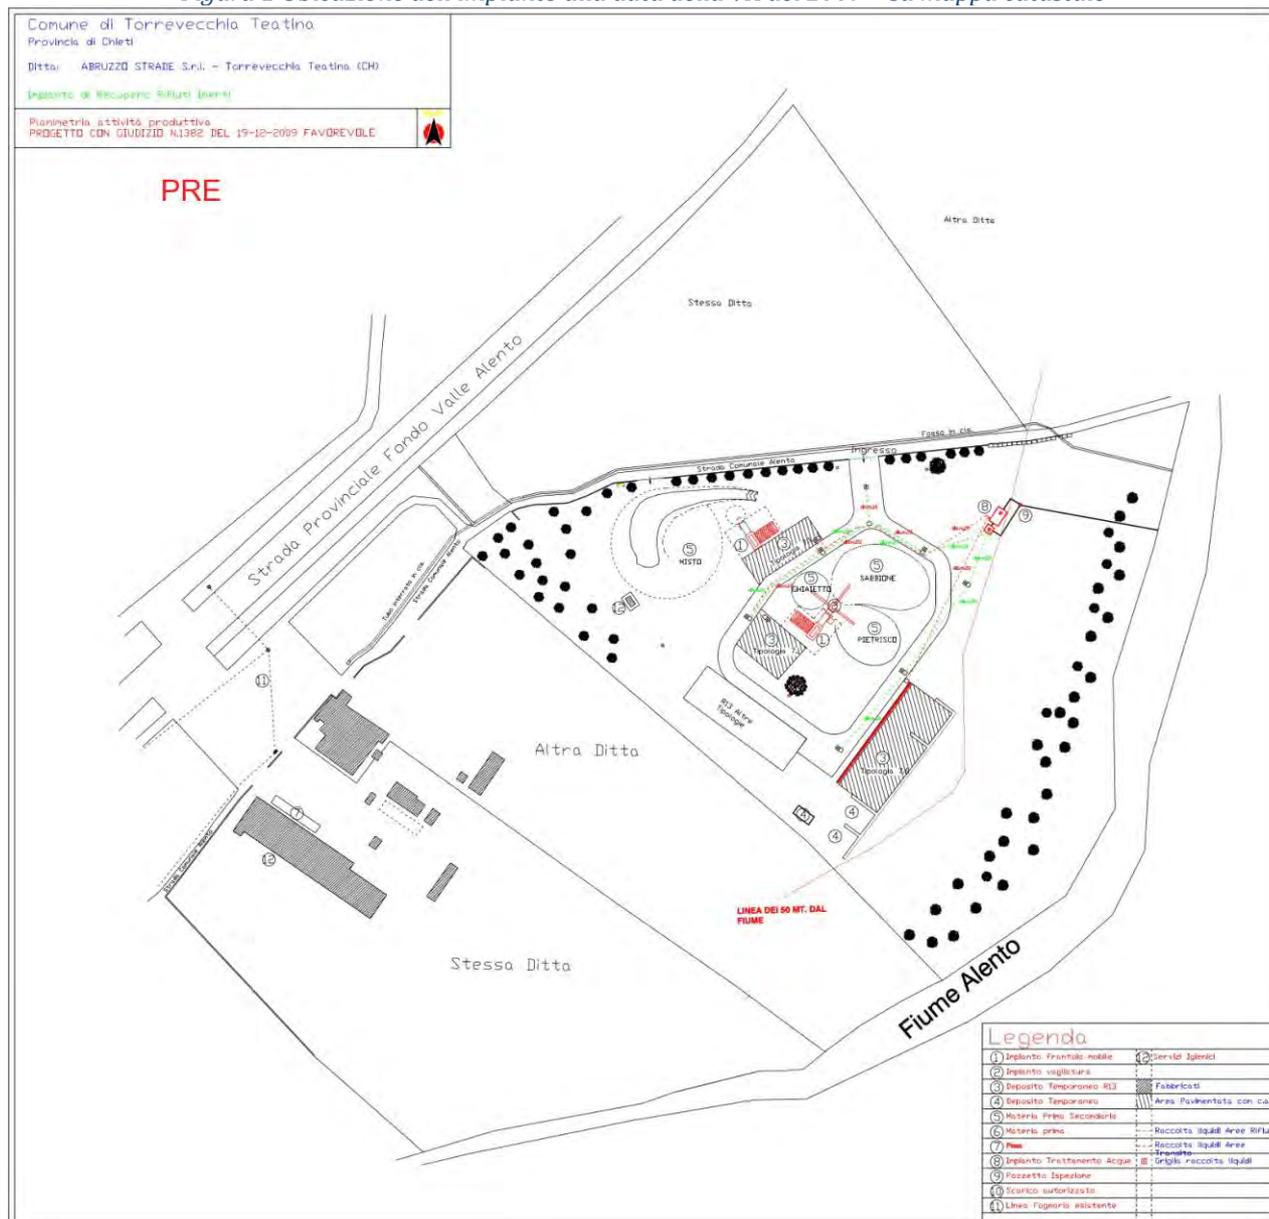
Planimetria assentita con Giudizio n.1382 del 19/12/2009
